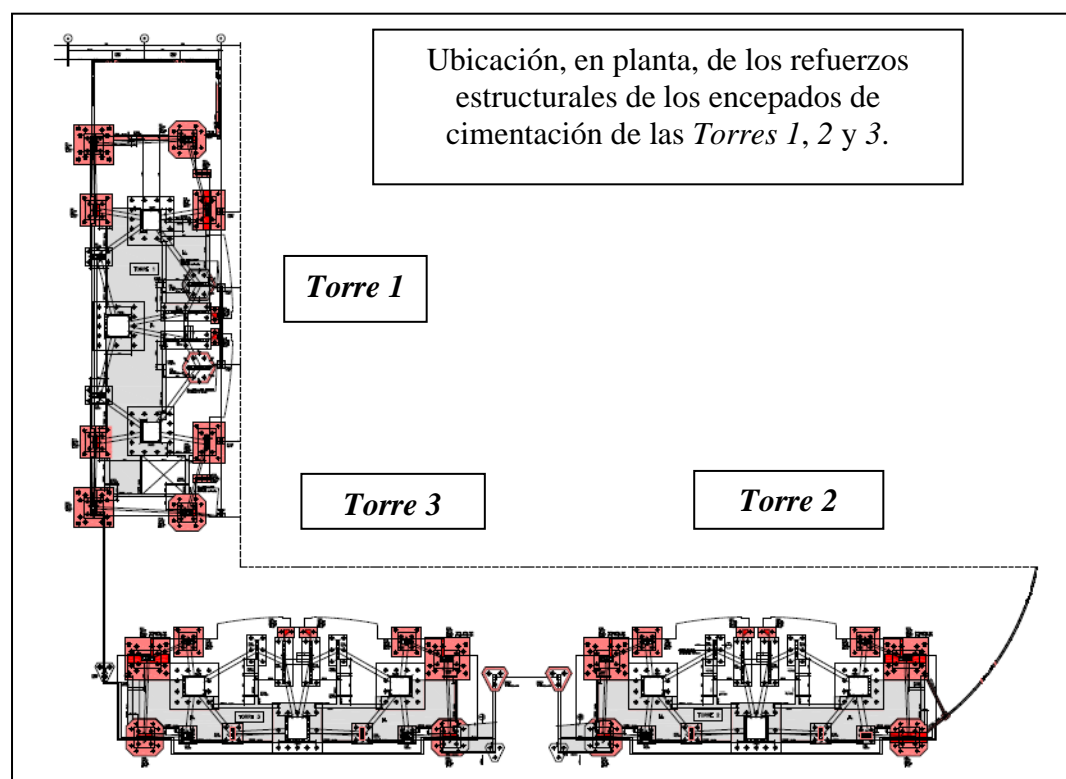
Detalle en planta, de la ubicación de los refuerzos estructurales de los encepados de cimentación de las torres residenciales.
